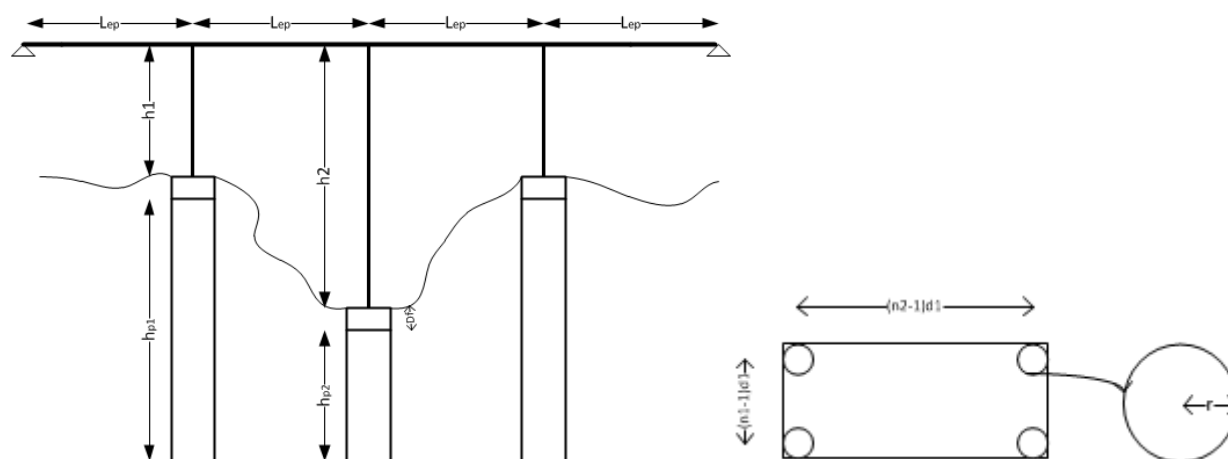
Sistema de cimentación a base de zapatas y pilotes propuesto para los modelos de análisis con interacción suelo estructura.
